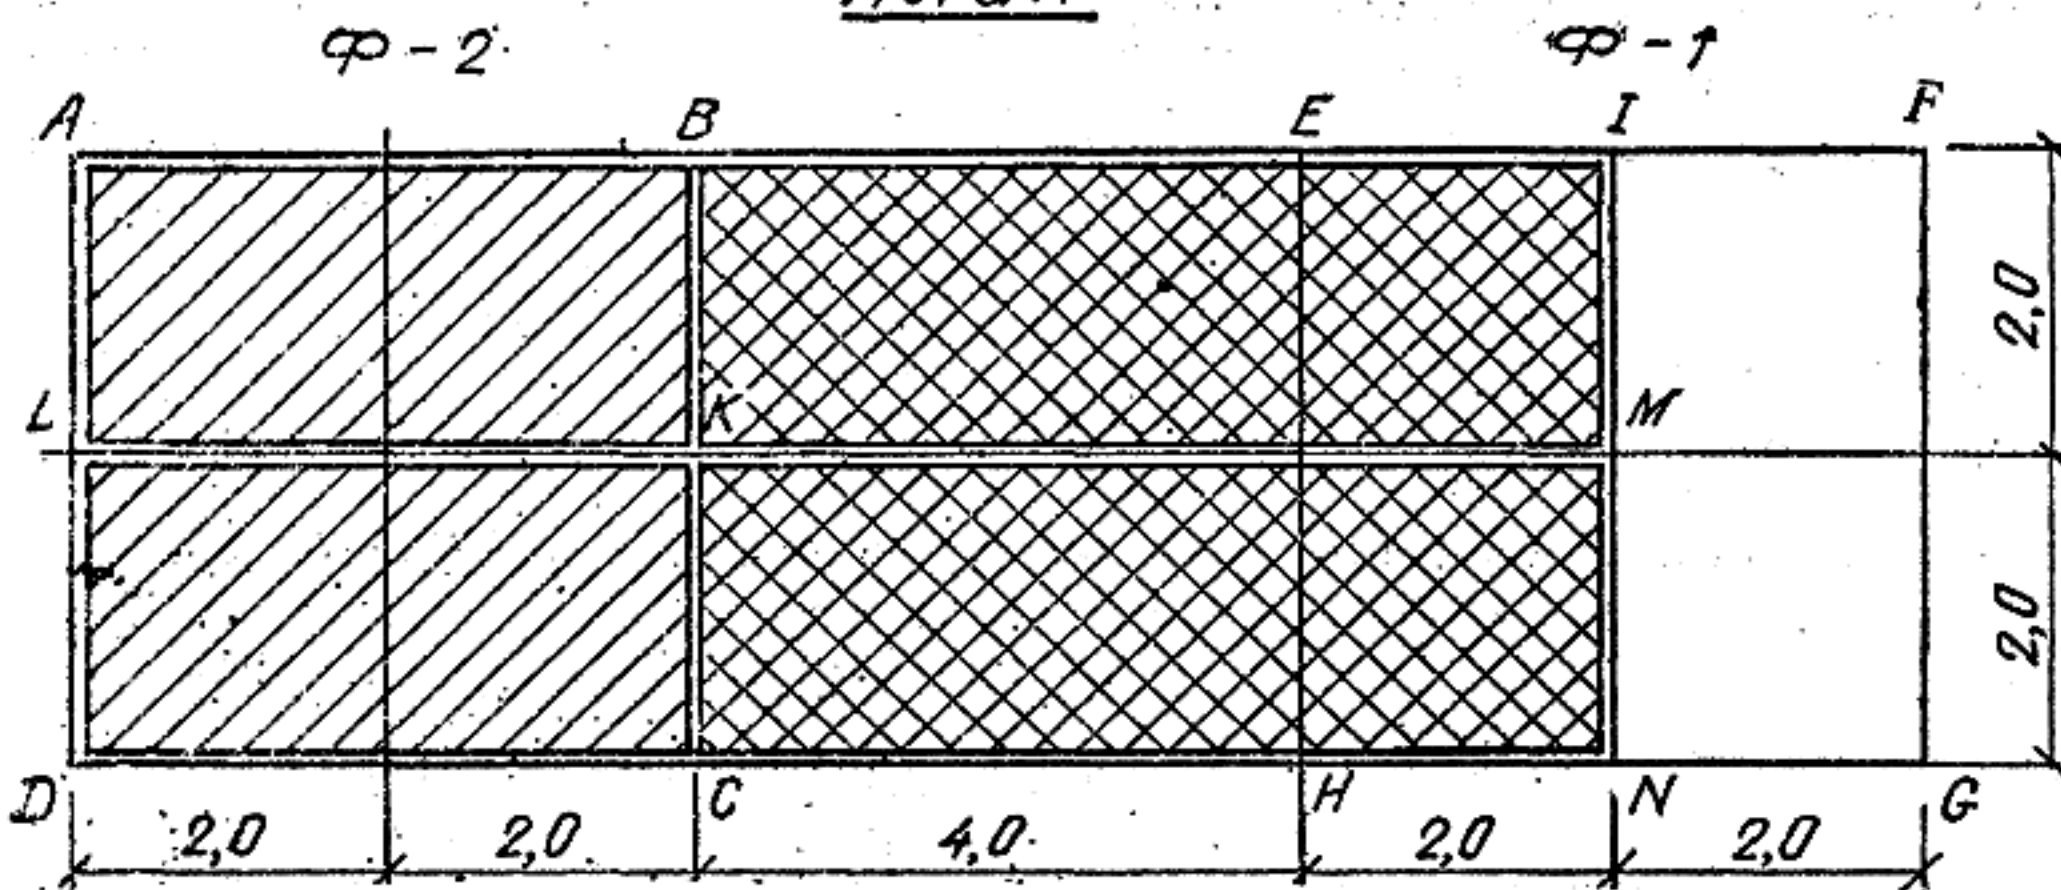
К определению вертикальных нормальных напряжений и расчету осадки фундамента с учетом влияния соседнего фундамента
